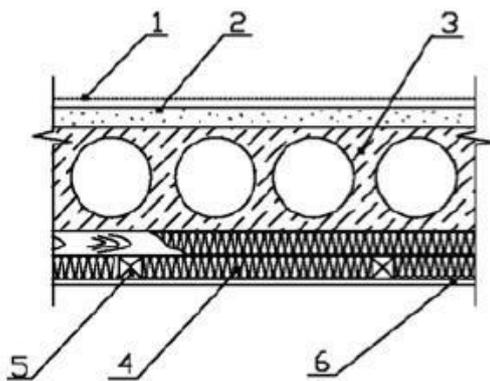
Улаштування теплогідрозвукоізоляції зі сторони першого поверху на перекритті із багатопустотних плит з застосуванням негорючого утеплювача
